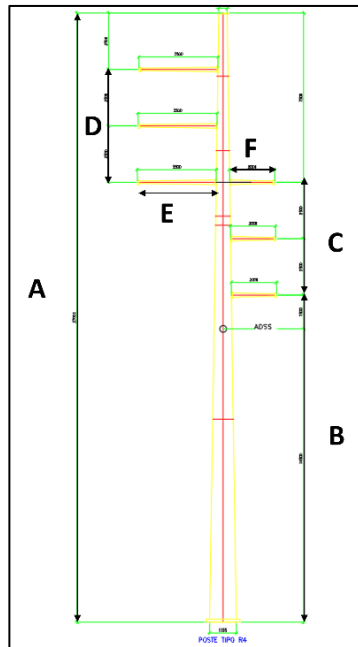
(a) Tipo y disposición de estructura poste 2783AN.
